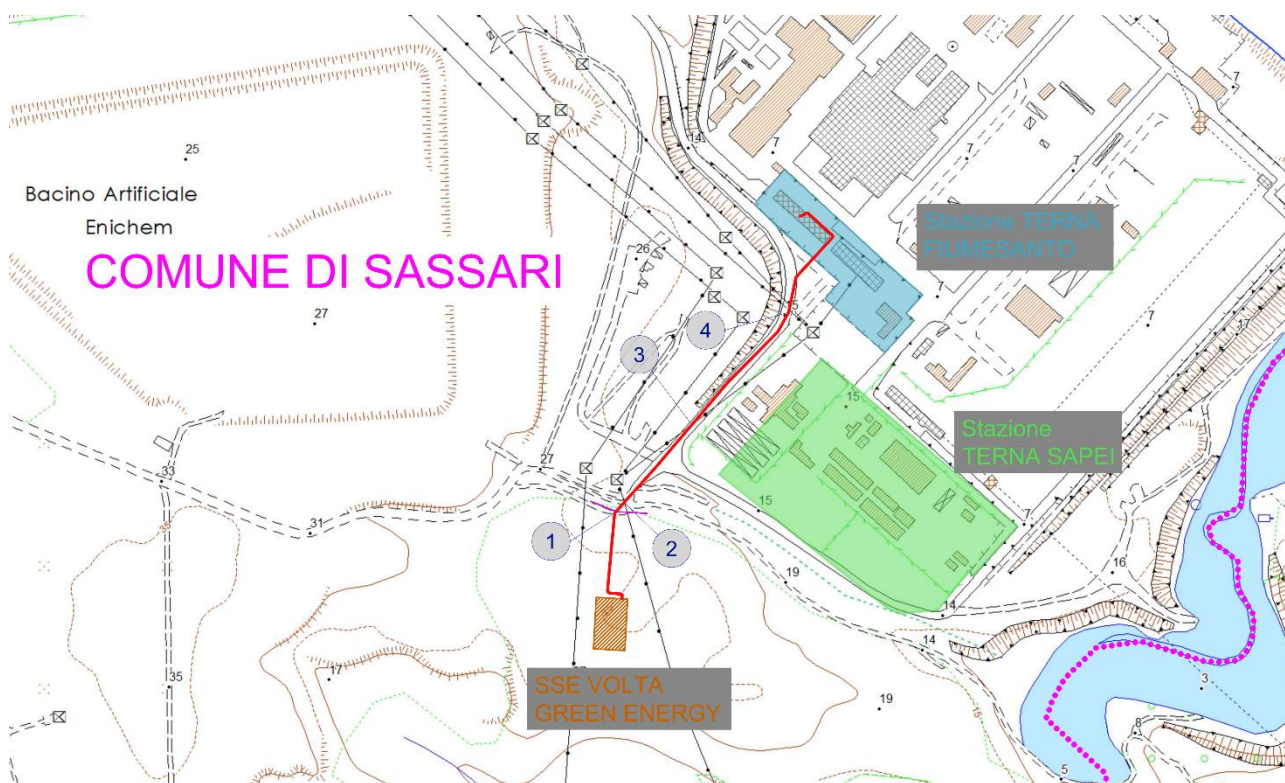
Inquadramento della stazione utente e tracciato cavo AT di collegamento con la stazione RTN
